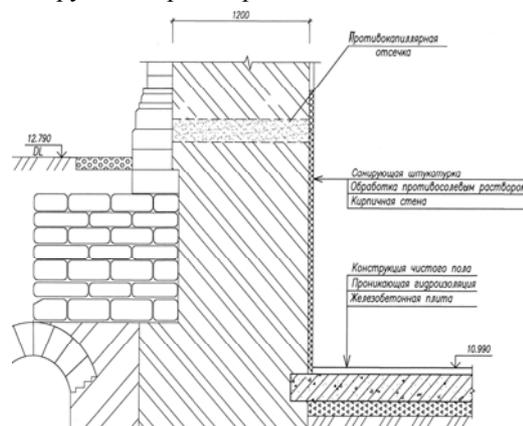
Устройство гидроизоляции и санации наружных стен цокольного этажа дворца
